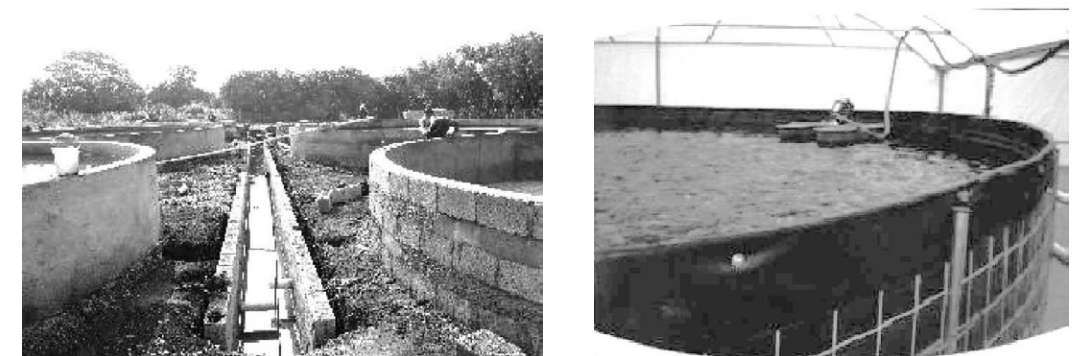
Los tanques circulares pueden construirse de block, concreto o con revestimiento de geotextil (un nylon de alto espesor y larga duración). Los estanques cuentan con un drenaje de aguas utilizadas ubicado al centro del estanque que permite la circulación de agua con agua con desechos o basura que se descargan a otros sistemas productivos o drenajes principales.
